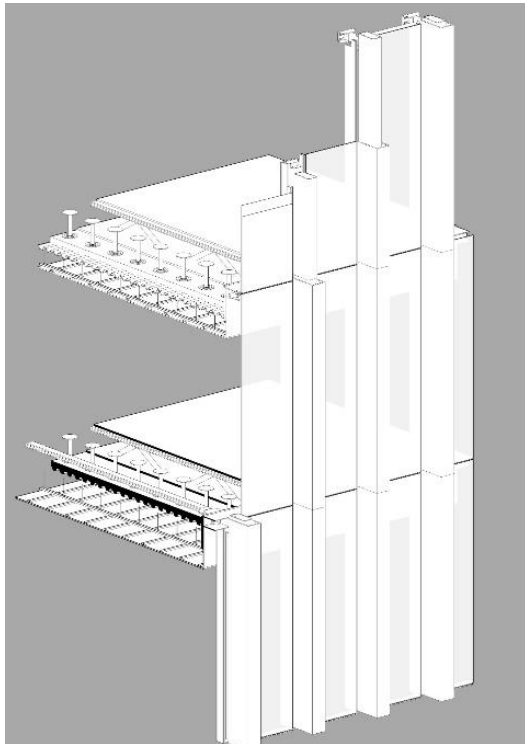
Corte tridimensional pormenorizado dos componentes estruturais
